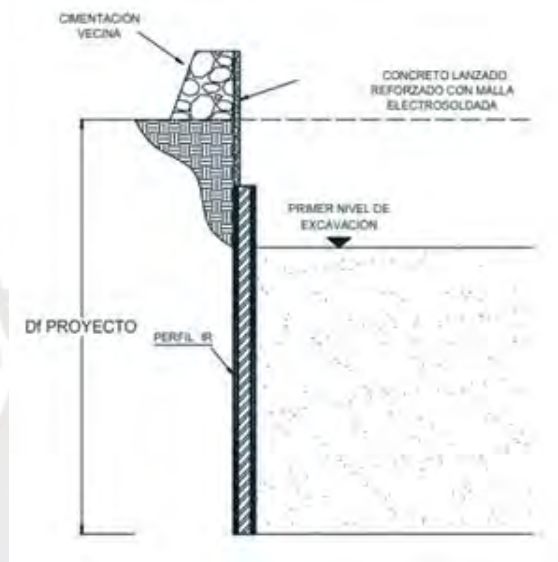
Primer nivel de excavación sin apuntalamiento. (Gerdau, 2017)
